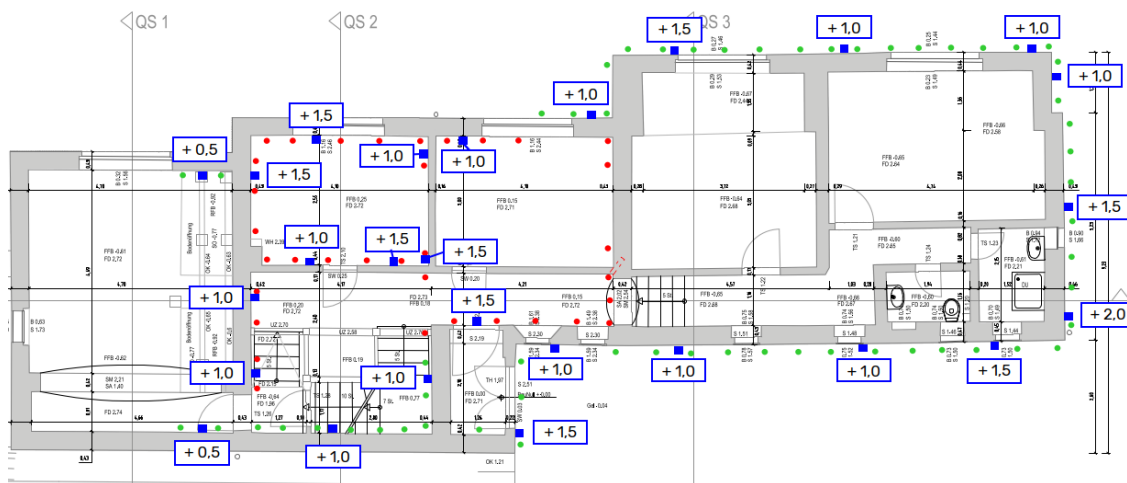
Ausschnitt aus dem Grundriss mit den zu ertüchtigten Streifenfundamenten. In Rot sind die Positionen der Injektionslanzen i bis 2,0 m Tiefe und in Grün die Injektionslanzen des Außenbereiches bis in 3,0 m Tiefe dargestellt. Die blau dargestellten Kästchen zeigen die Positionen der Laserempfänger. Es wurden Hebungsreaktionen von 0,5 mm bis 2,0 mm an der aufgehenden Konstruktion registriert.
